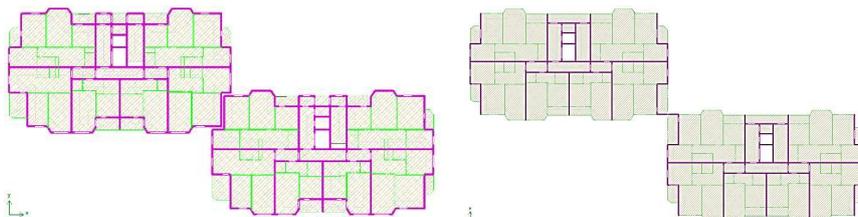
Варианты расчётных схем: слева – здание с монолитными продольными и поперечными стенами; справа – здание с монолитными поперечными стенами и с продольными из пенобетонного заполнения
